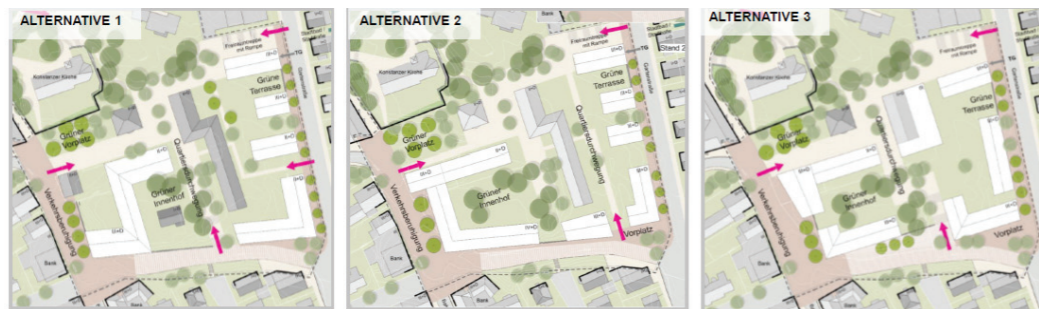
Entwurfsvarianten Areal Wilhelmschule, Plan: ISA
